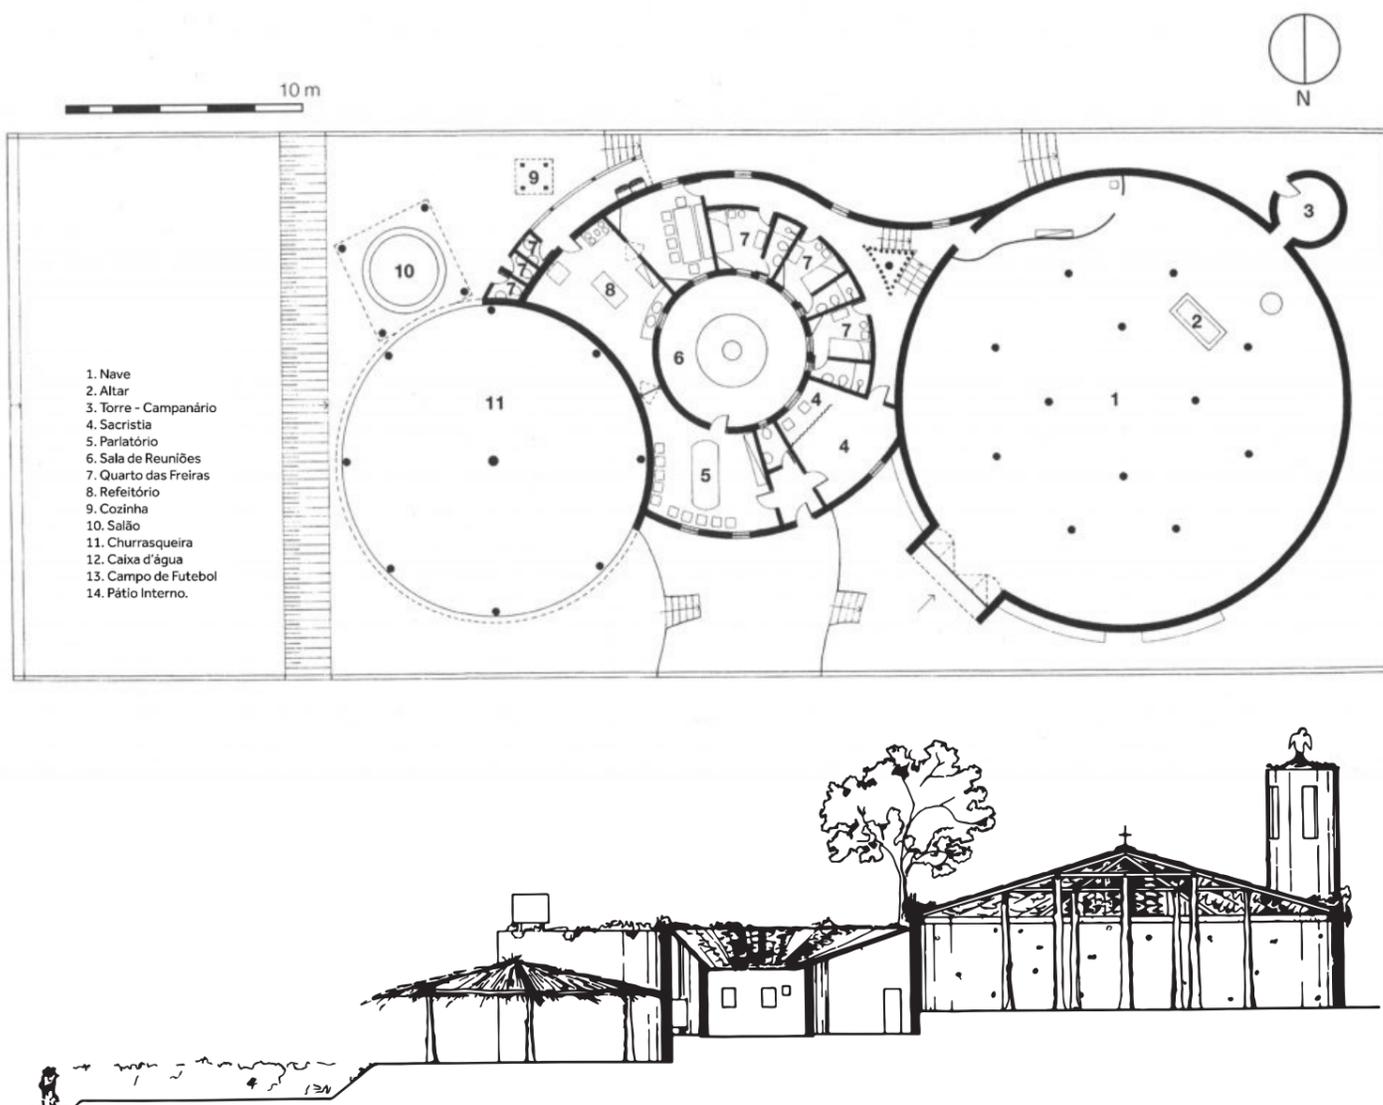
e 07. Planta Baixa e Elevação lateral. Fonte: Hidden Architecture, 2019.
